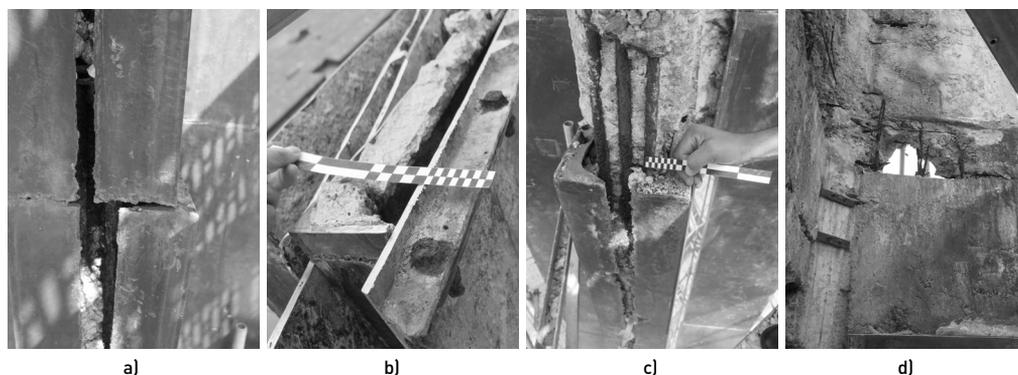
Degradação do betão armado e sistema de fixação das chapas de latão © IC, 2019
